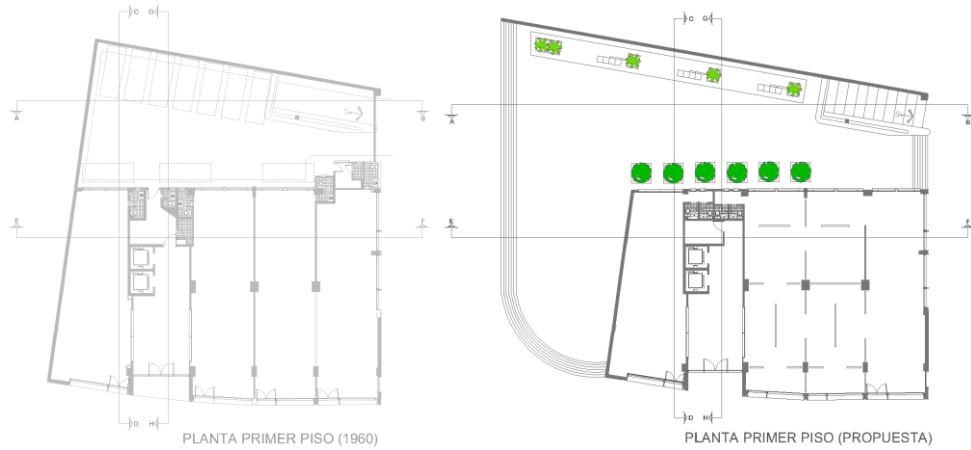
Edificio Tissot, construido en 1960* (Autoría propia).
